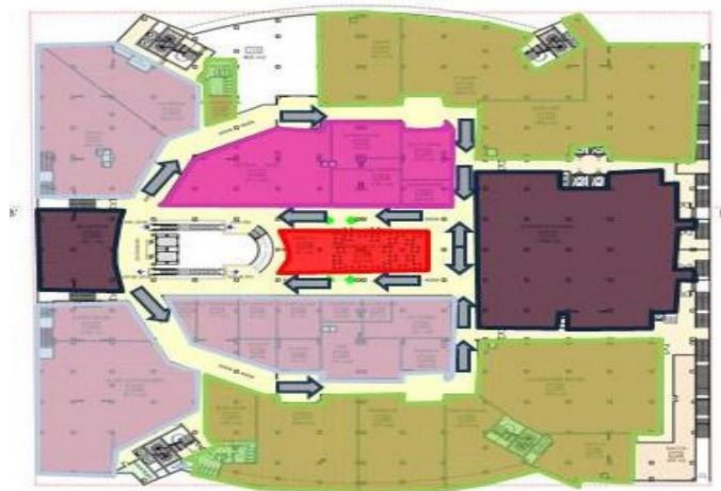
Vue en plan du R+1 du centre commercial de Bab Ezzouar.
